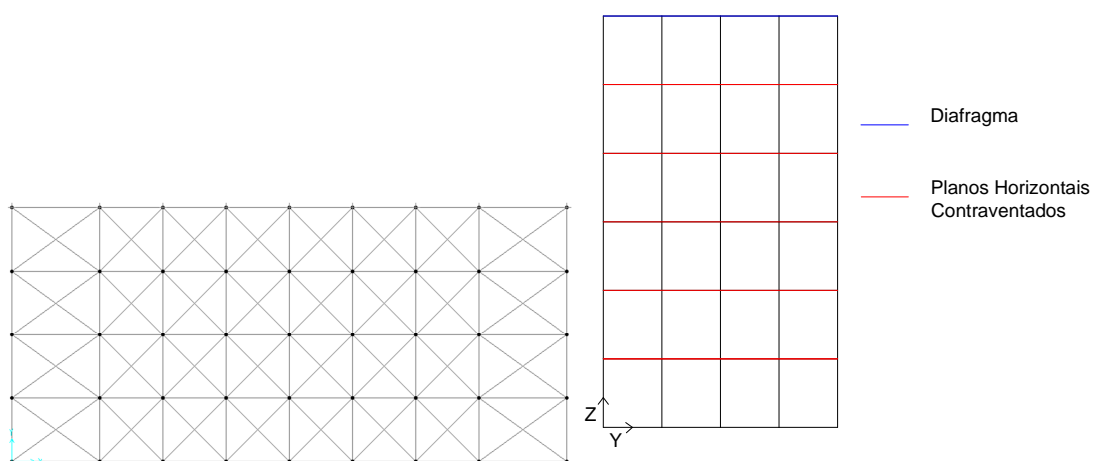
Configuração dos Planos de Contraventamento Horizontal Com Elementos de Contraventamento Pequenos
